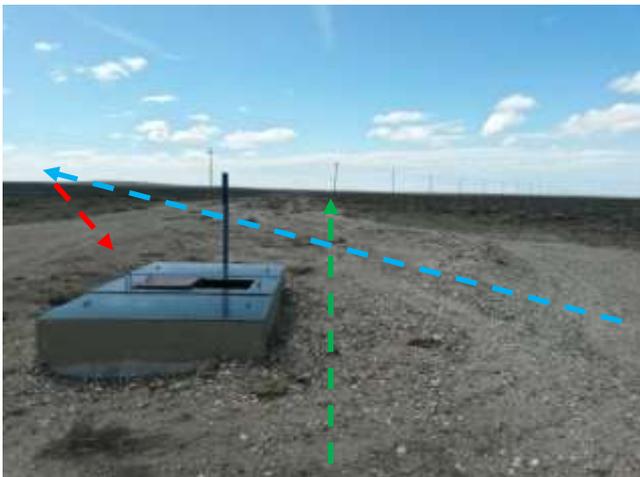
Emplazamiento de acueducto por picada existente. (Verde). Válvula de bloqueo N° 1 (rojo). Foto en dirección O.
